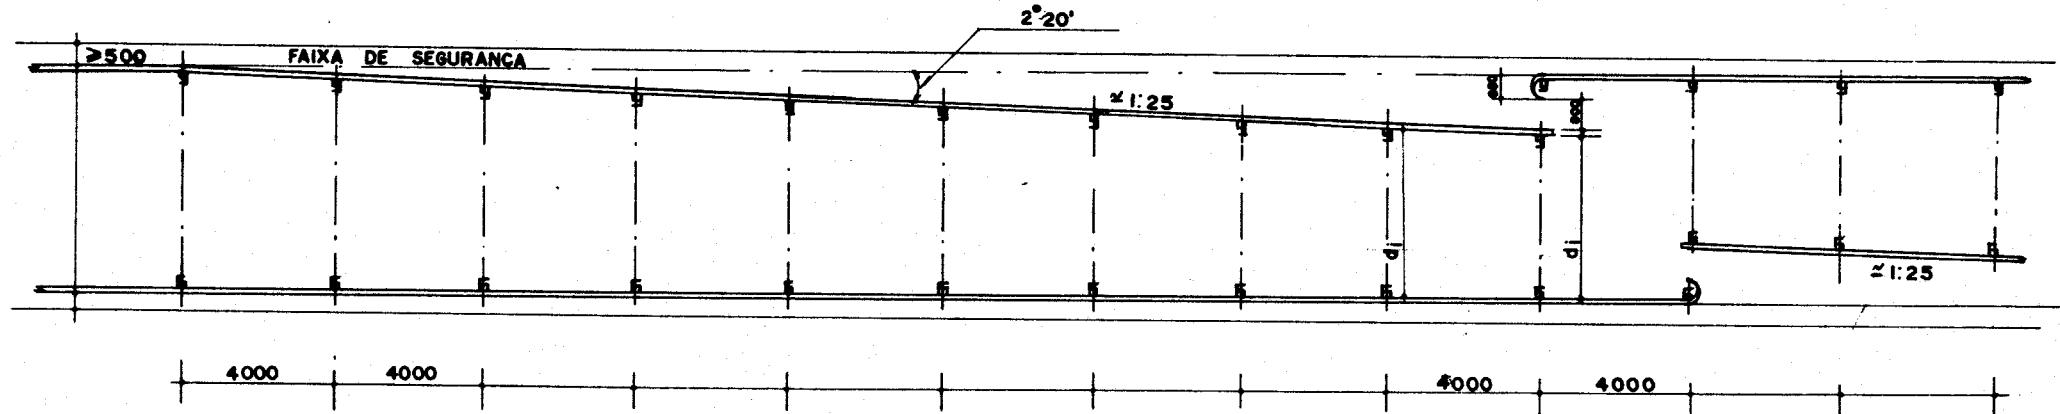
DEFESA EM CANTEIRO SEPARADOR
